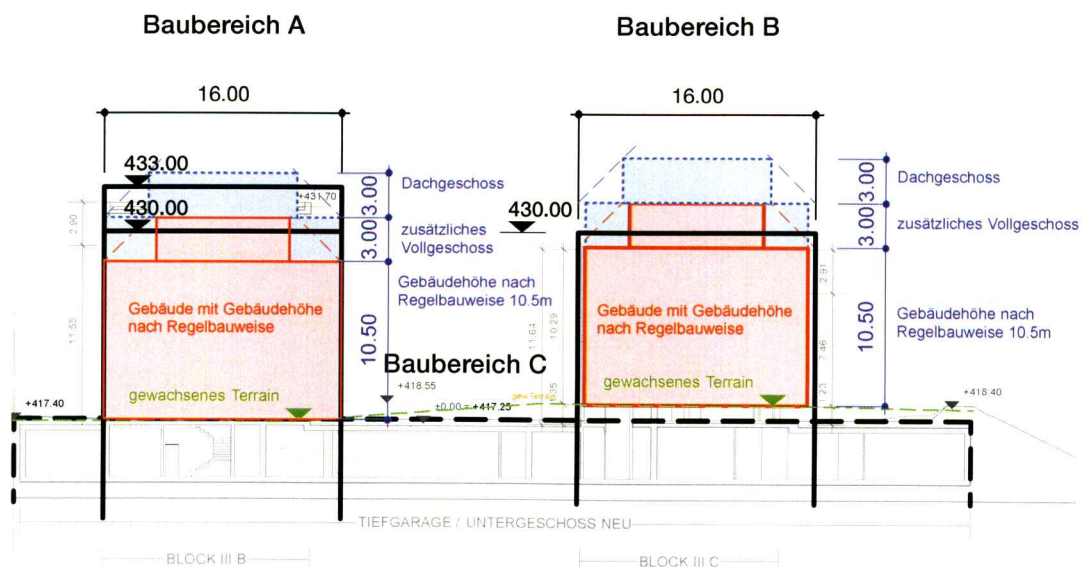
Gestaltungsplan Schnitt 2, Vergleich der möglichen Gebäudehöhen
